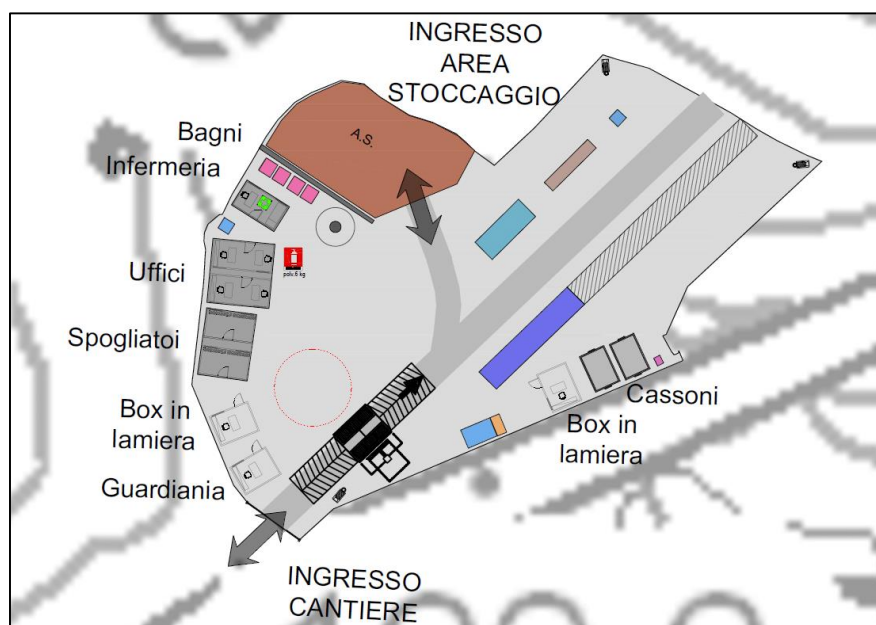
Layout cantiere operativo all'imbocco sud (CO 01).
